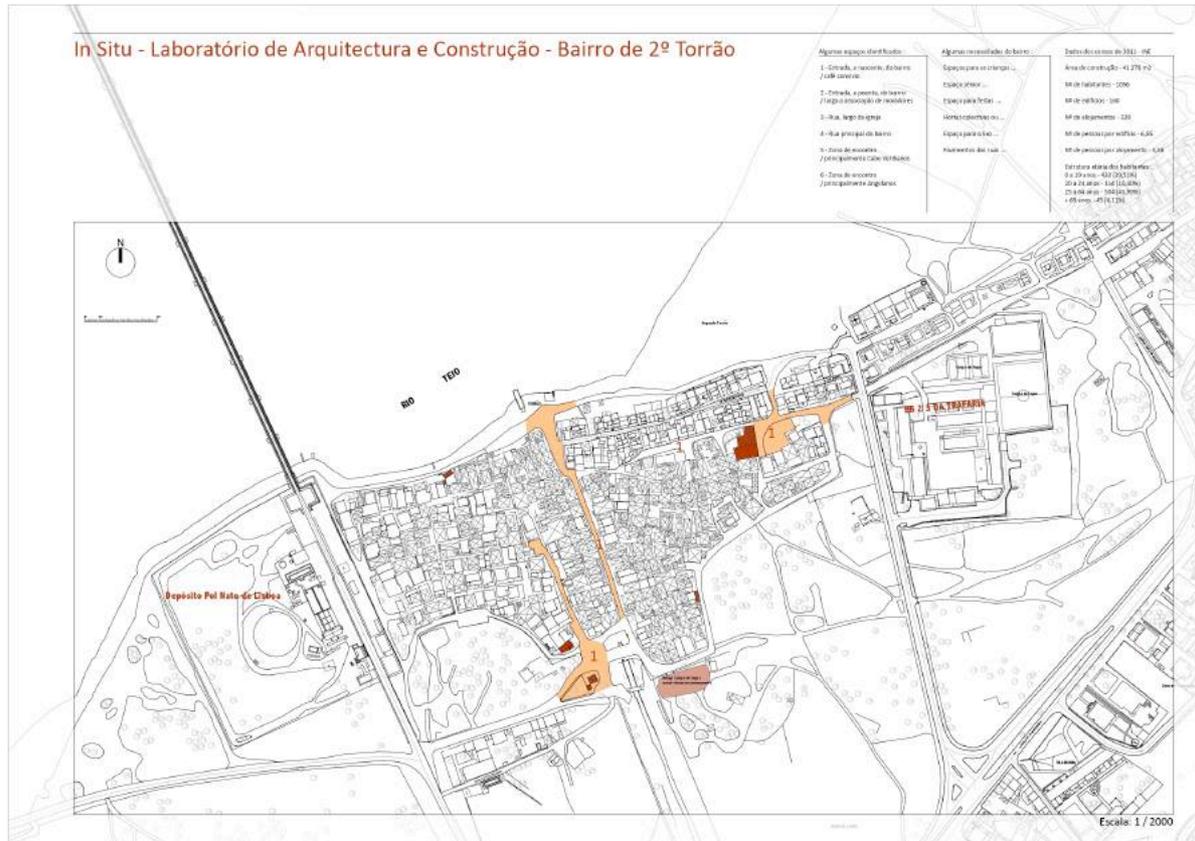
Planta do existente, Bairro do Segundo Torrão
